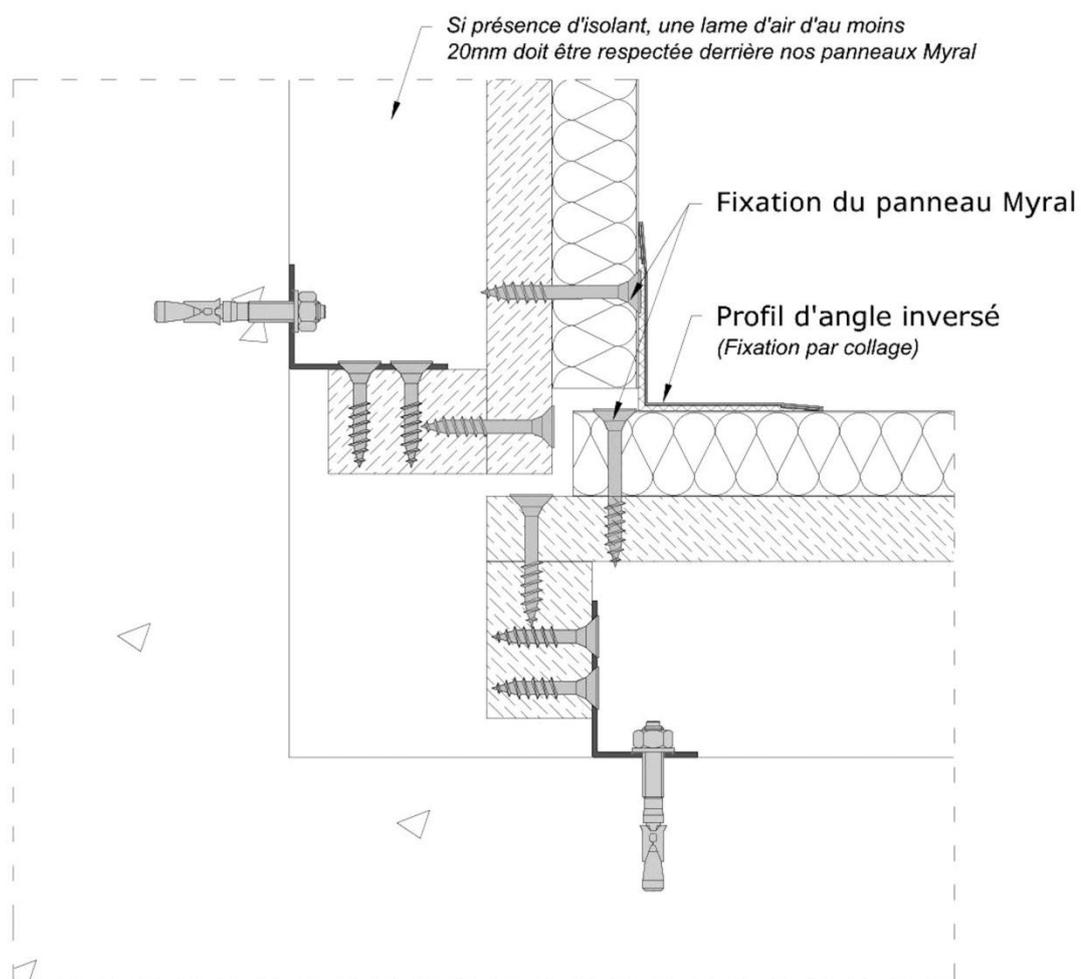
Angle rentrant – Pose en vêlage, pose verticale (coupe horizontale)
